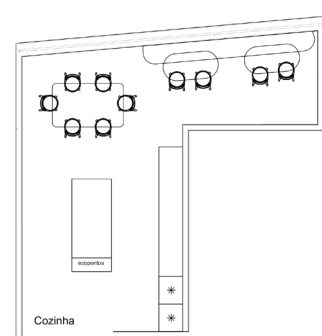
terceiro esboço da cozinha. Fonte: autora, em autocad.
